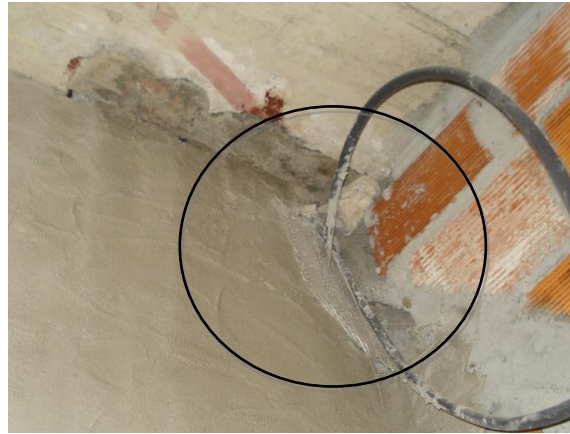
Pormenor de preenchimento dos roços (Sara Ferreira, 2013)
